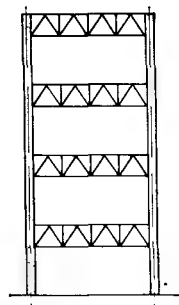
Рамный каркас с фермами-ригелями, располагаемыми в технических этажах
